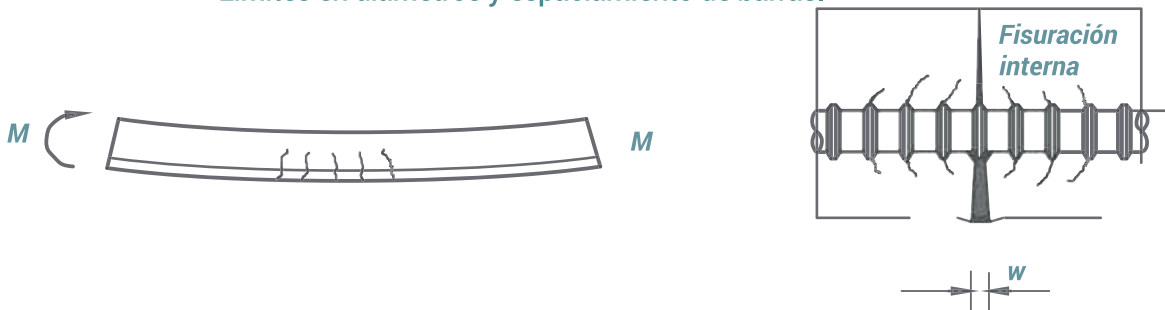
Agrietamiento en vigas de concreto reforzado.
